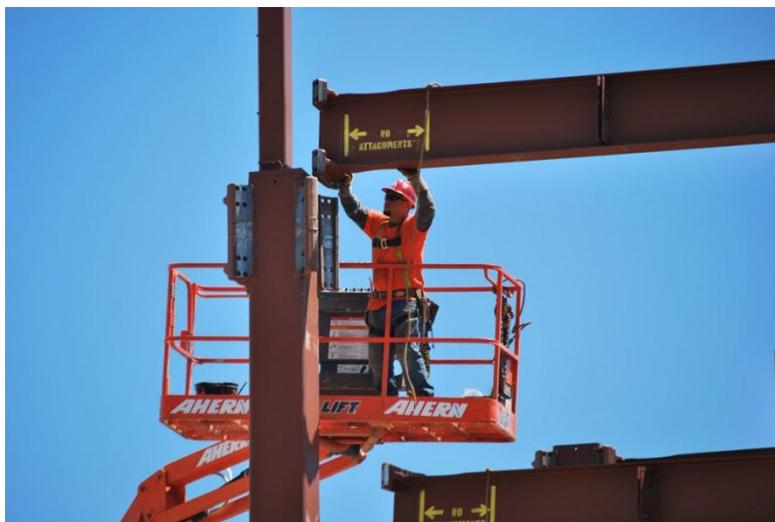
Montagem de estruturas em aço com ligação ConX-L.
